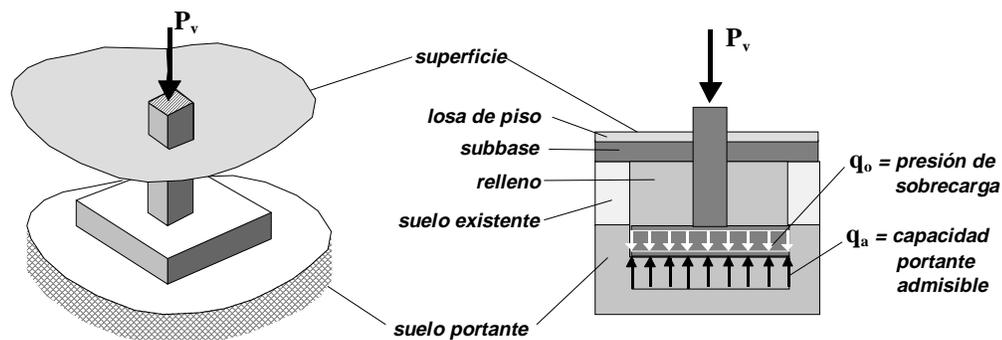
Fuerzas que actúan sobre la zapata
